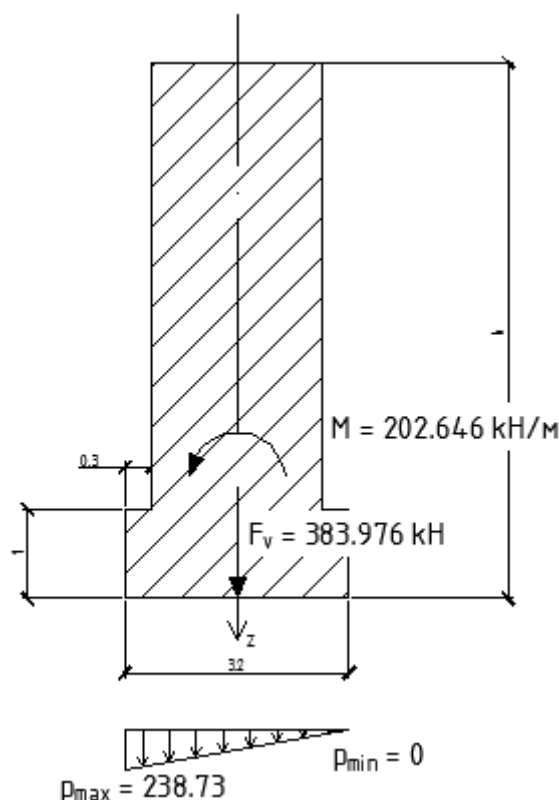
Определение ширины фундаментной части стенки и усилий по подошве
